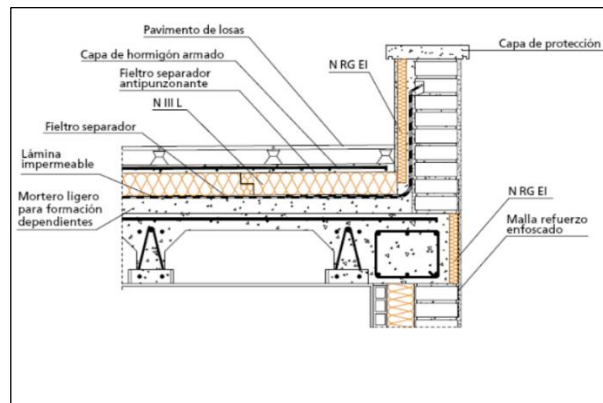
Cubierta en pavimento. REY DE CABO Lara del, GONZÁLEZ SÁNCHEZ Elena , Otros. *Cubiertas Horizontales Transitables. Cubiertas Drenadas. Cubiertas Invertidas.* 2012
